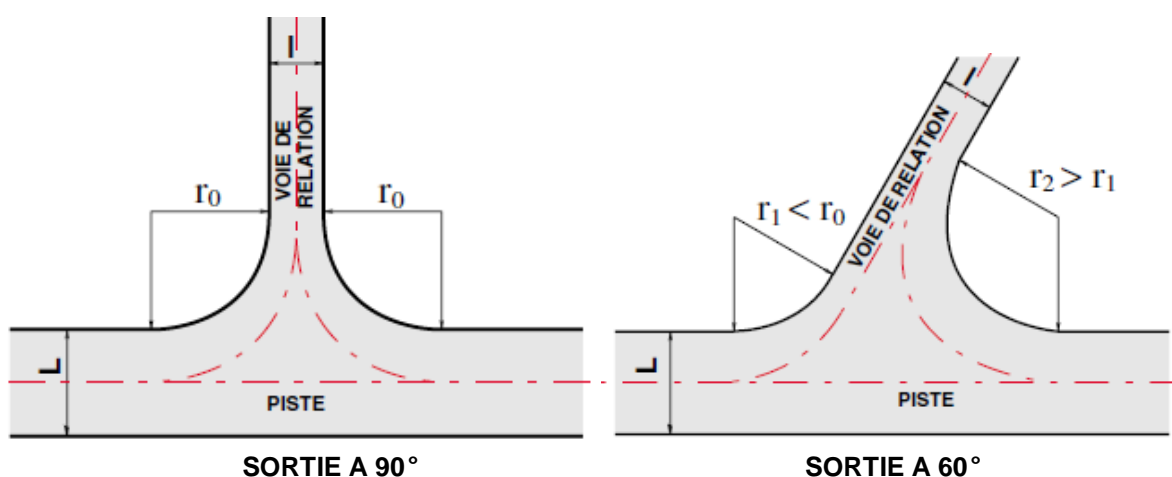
Intersection entre une piste et une voie de relation à 90° et 60°
